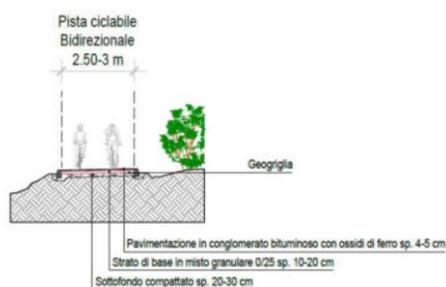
Sezione tipo della pista ciclabile bidirezionale
